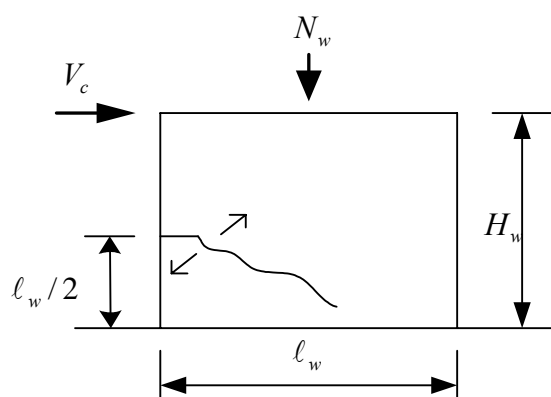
鋼筋混凝土牆撓剪開裂示意圖
